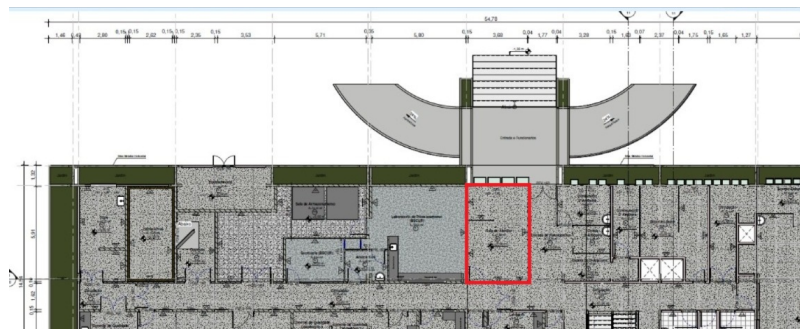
Planta baixa do bloco A, Térreo, da FHB, onde se localiza a sala de aférese (área destacada em vermelho).
